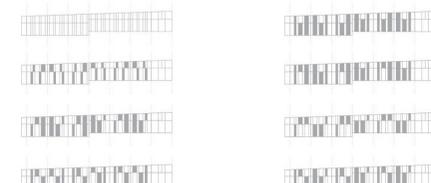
Cubierta del centro de salud de Adamsville. Plataforma Arquitectura (2013)
